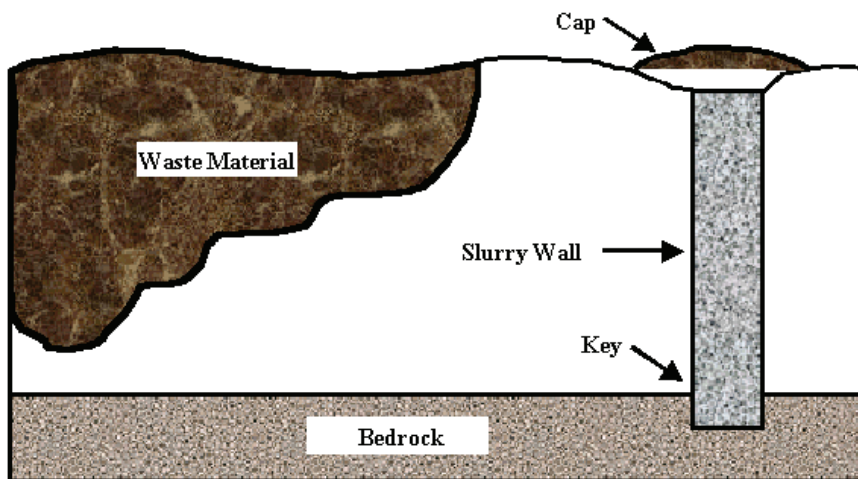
Изоляция с применением накрытых стен в грунте (в разрезе)
